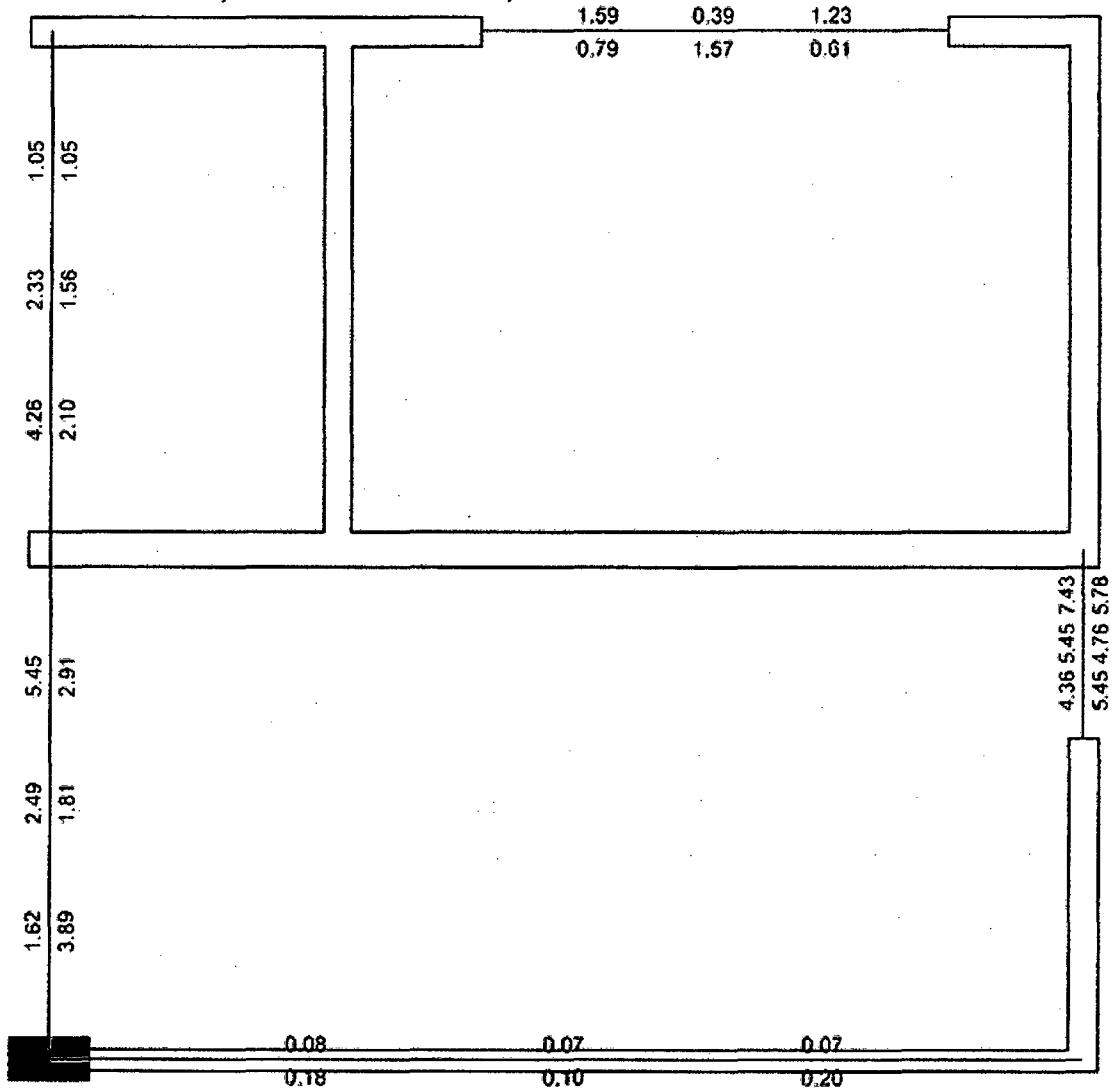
, Estructura convencional, Verificación de elementos estructurales - Piso 5.
